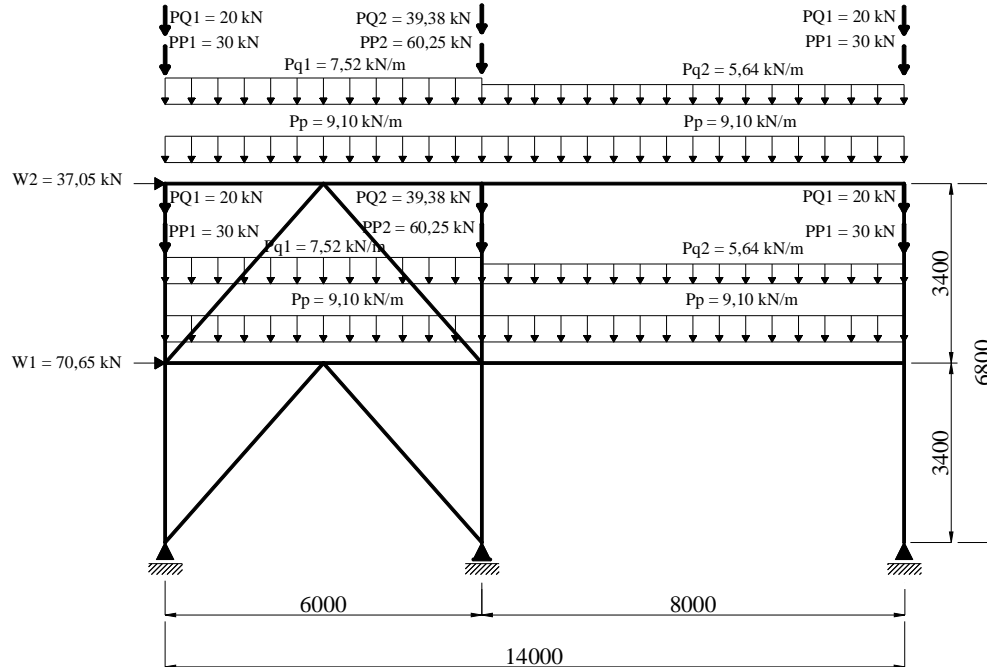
Pórtico contraventado de dois pavimentos (dimensões em milímetros e ações com valores característicos)
